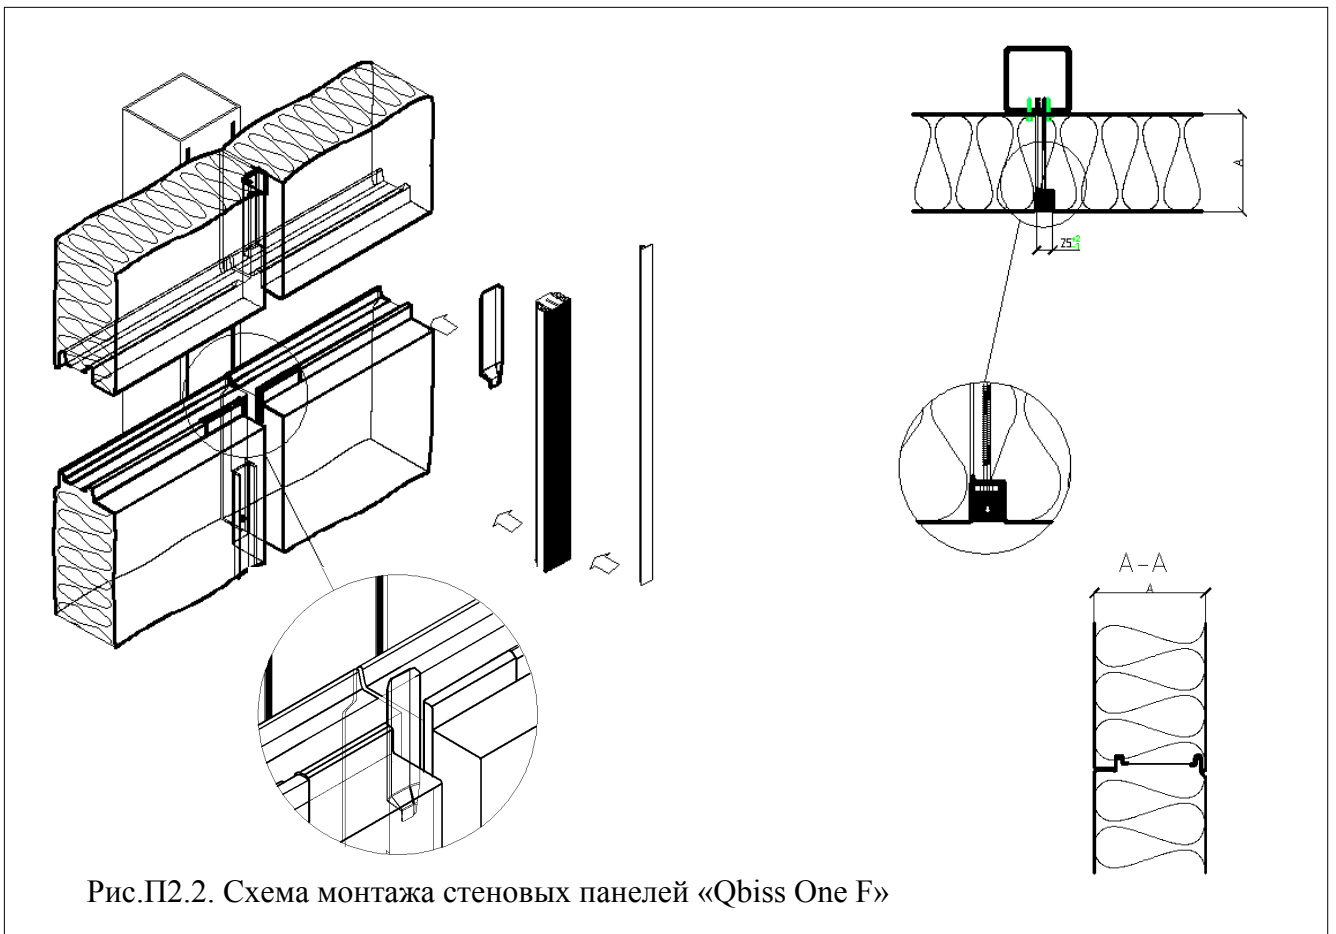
Схема монтажа стеновых панелей «Qbiss One F»
